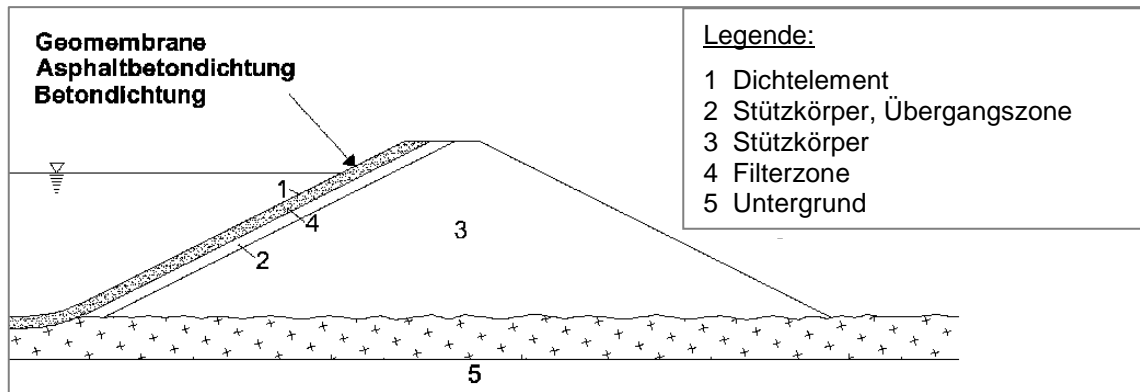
Damm mit Außendichtung [59: S. 22]
